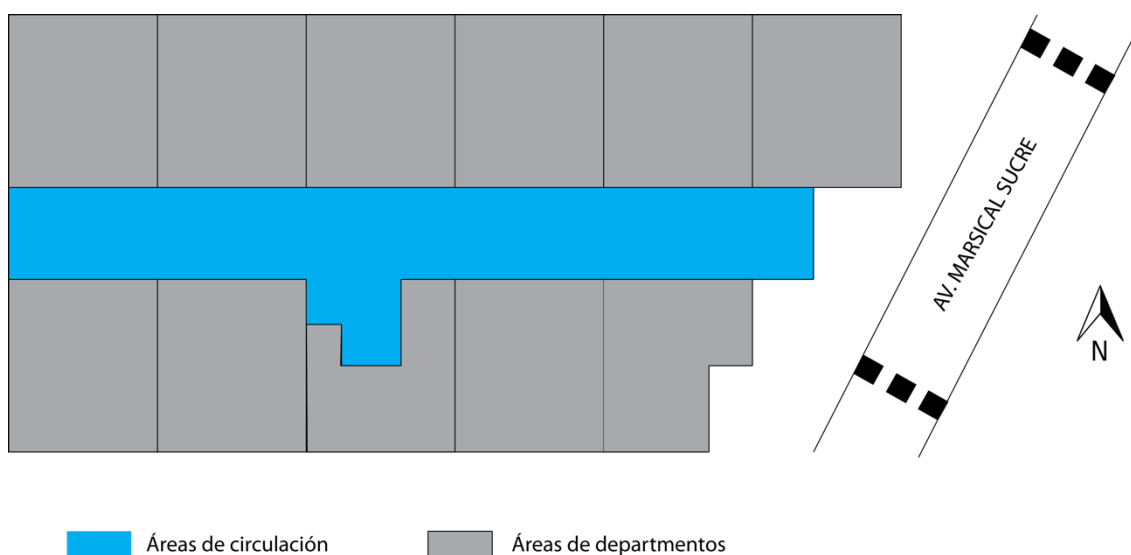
Distribución esquemática de la planta tipo sobre nivel 0 del proyecto.
